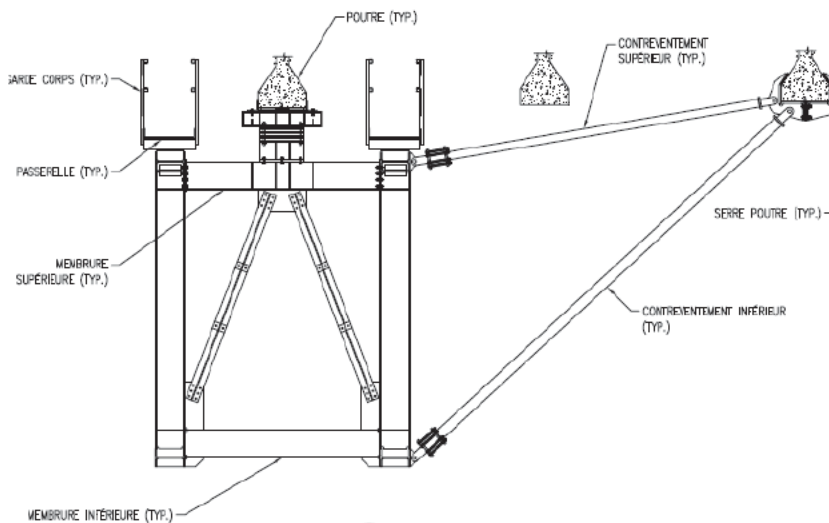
Poutres en béton – Renforcement par treillis modulaire pour QP1 (QP1 non-monté) – coupe transversale (source : plans nomenclature PJCCI)
